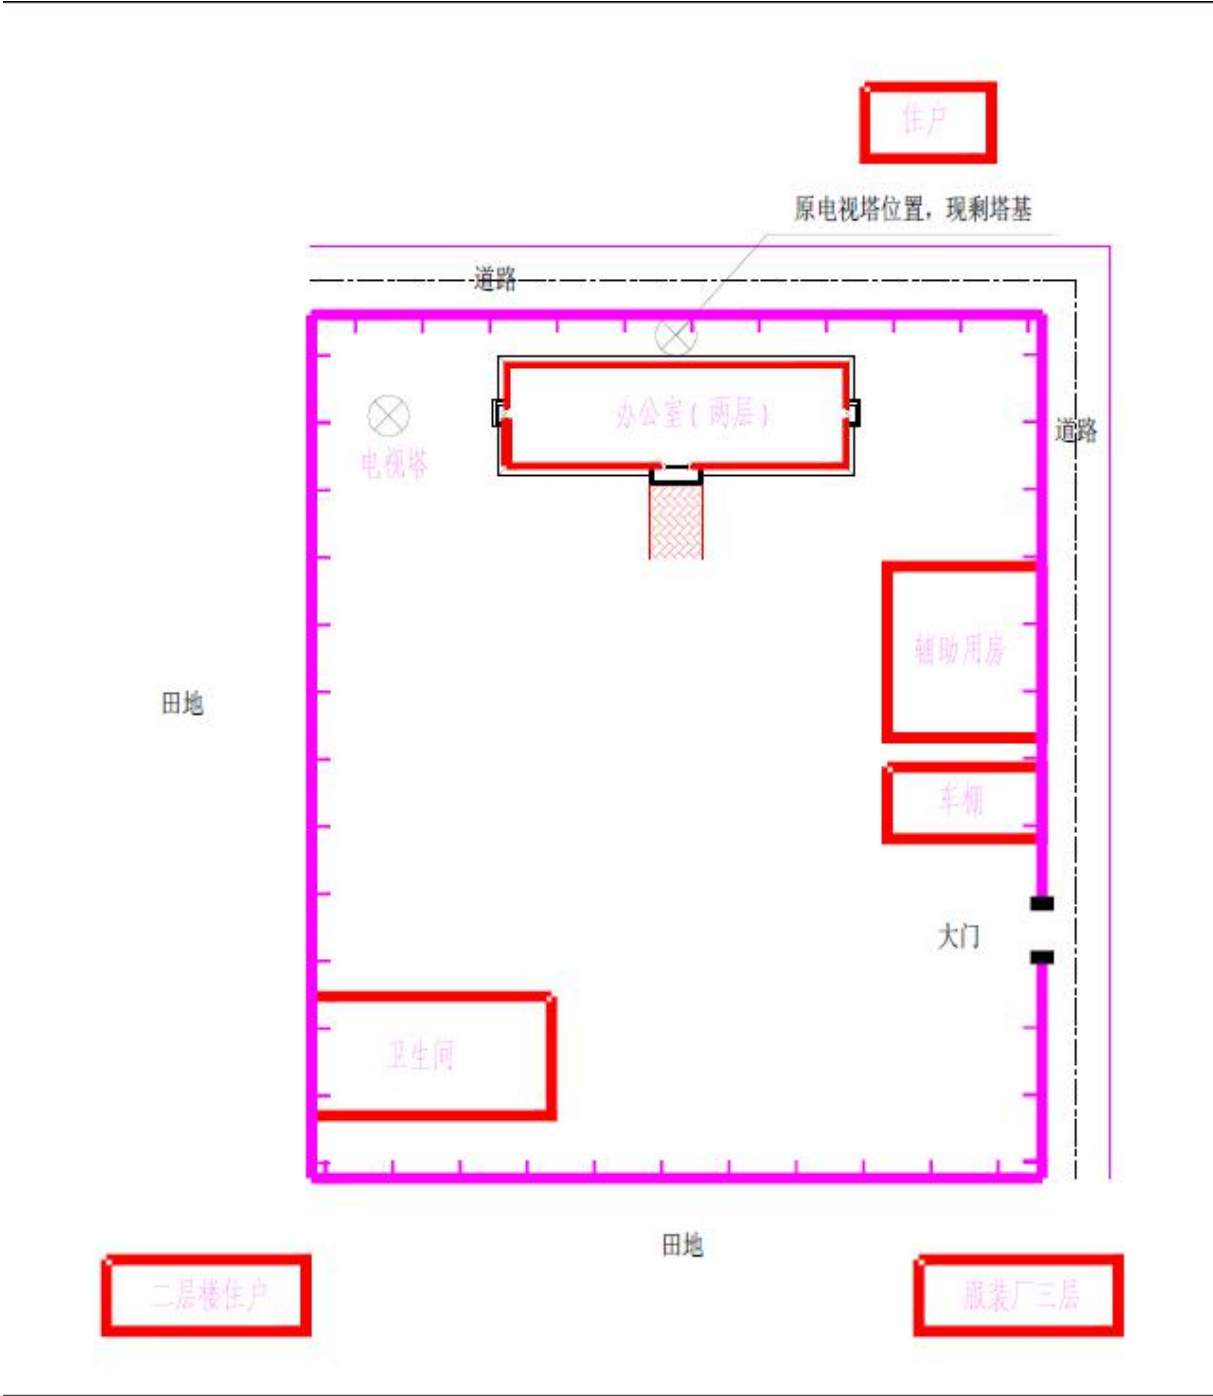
泌阳下碑寺融媒体中心新建差转台平面布置图
